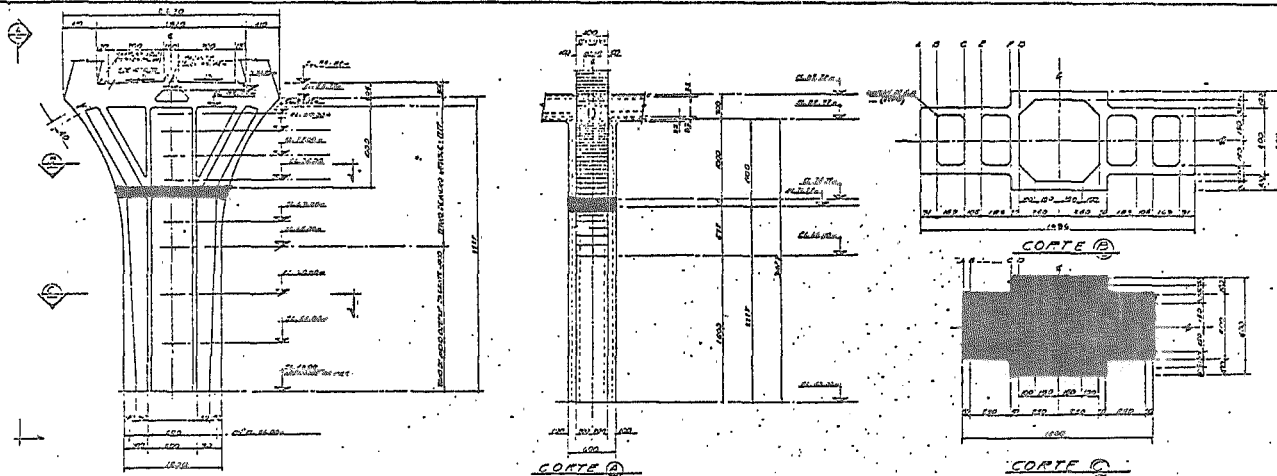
COLADO DEL DIAFRAGMA. PILAS 4 Y 5
